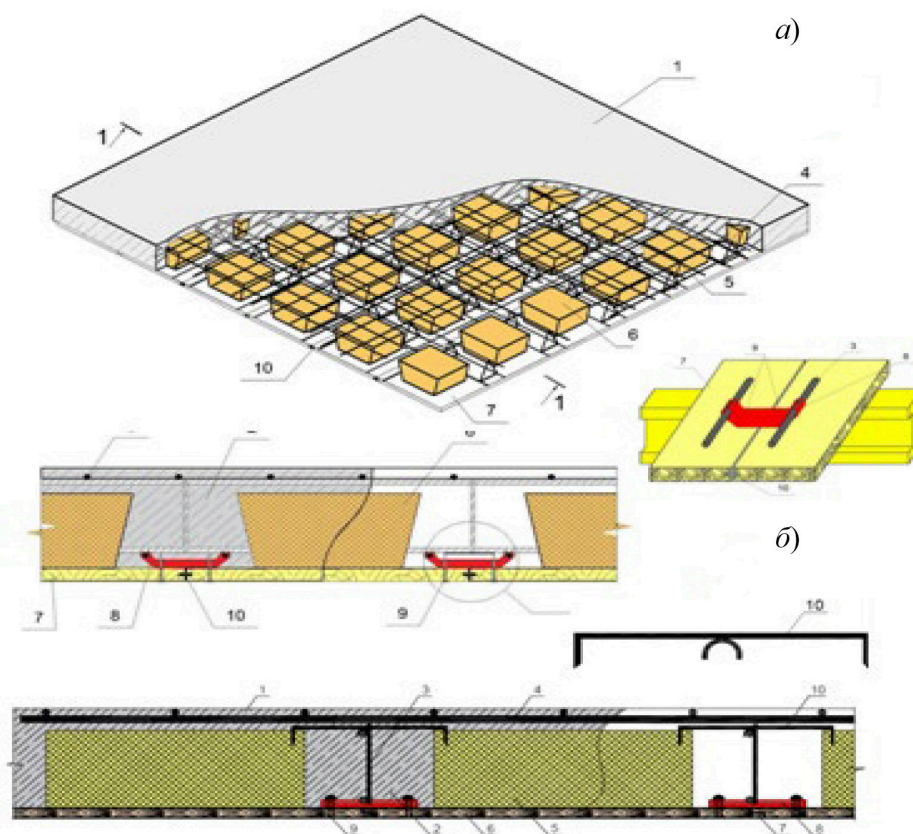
Усовершенствованное сборно-монолитное железобетонное перекрытие по базовой VELOX-технологии: а) с пространственным арматурным каркасом: 1 – сборно-монолитная плита; 2 – монолитная балка; 3 – арматура; 4 – арматурные каркасы треугольной формы поперечного сечения; 5 – арматурная сетка плиты; 6 – вкладыши из пенополистирола или короб из арболита; 7 – несъемная дощатая опалубка; 8 – фиксаторы положения нижней арматуры; 9 – винты-саморезы; 10 – шпунтовое соединение досок из арболита; б) с плоским вертикальным каркасом: 1 – плита; 2 – балка; 3 – каркас; 4 – сетка; 5 – вкладыш из пенополистирола; 6 – доска; 7 – шипованное соединение; 8 – соединительная планка из пластмассы с пазом для каркаса 3; 9 – самонарезные винты; 10 – распорка-фиксатор каркаса 3
